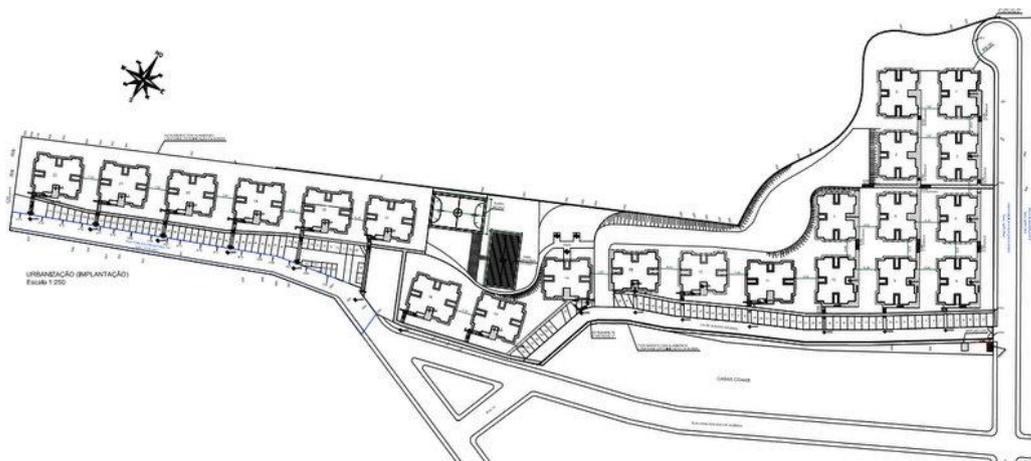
Planta de implantação do Conjunto Habitacional (Fonte: a equipe - sem escala)
